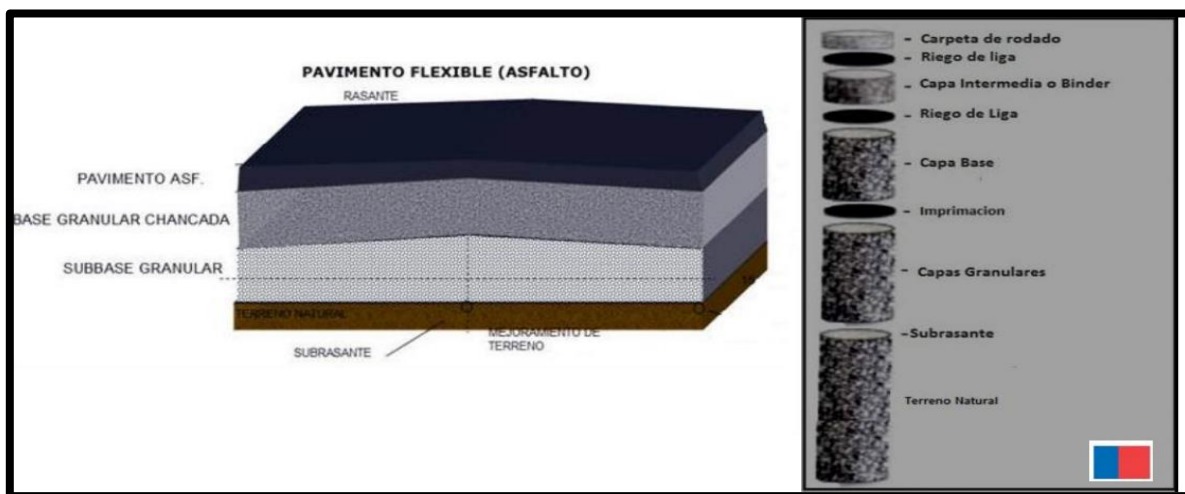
Distribución de las capas estructurales de un Pavimento Flexible. Fuente [13].
